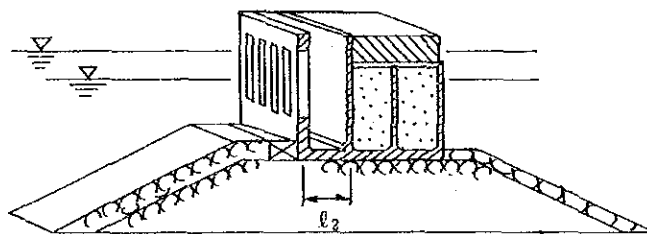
(d) 岸壁 (-12m) ⑩標準断面図
